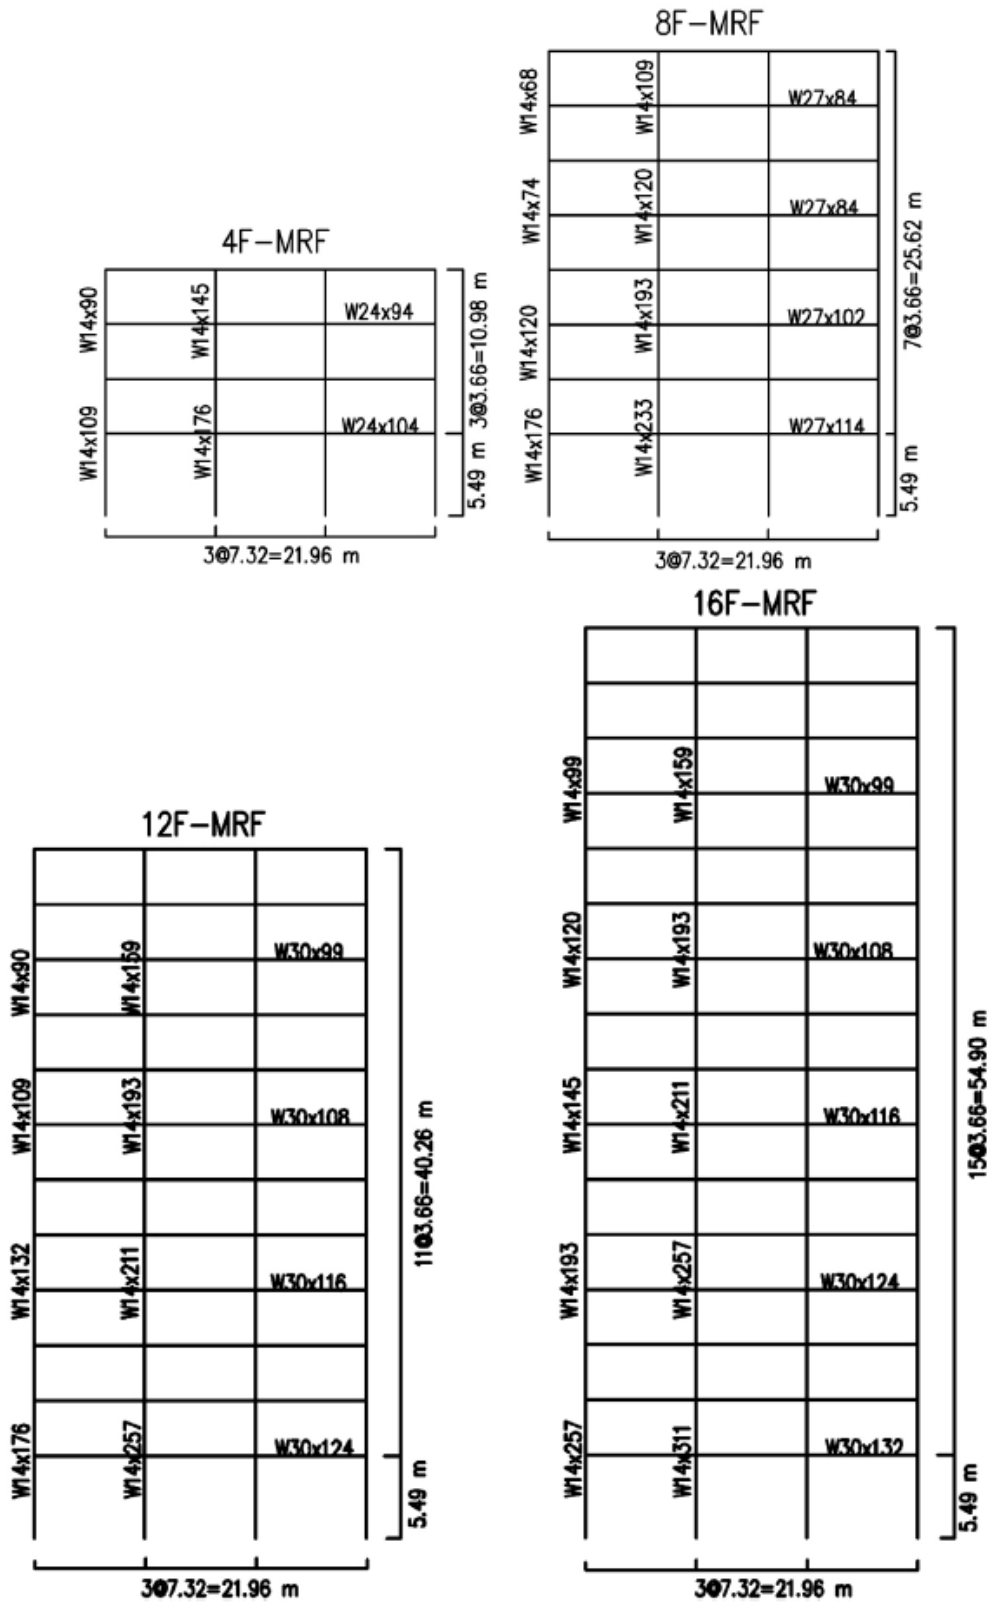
Vista en elevación de estructuras de 4, 8, 12 y 16 pisos con MRFs (Fuente: Nassani, 2017).
